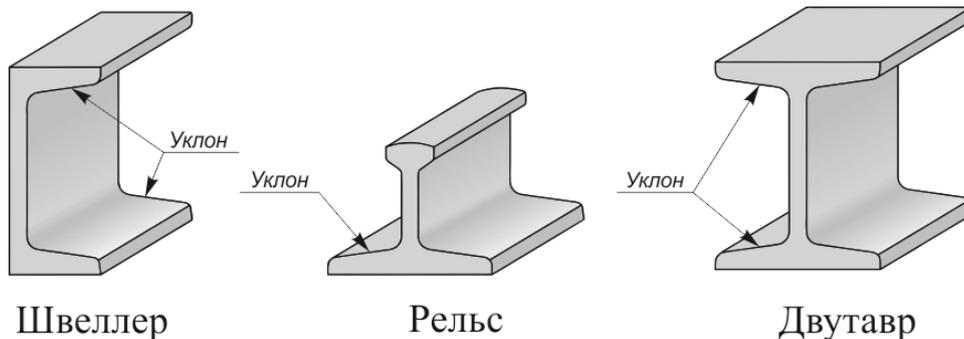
Стальной фасонный прокат для металлоконструкций
